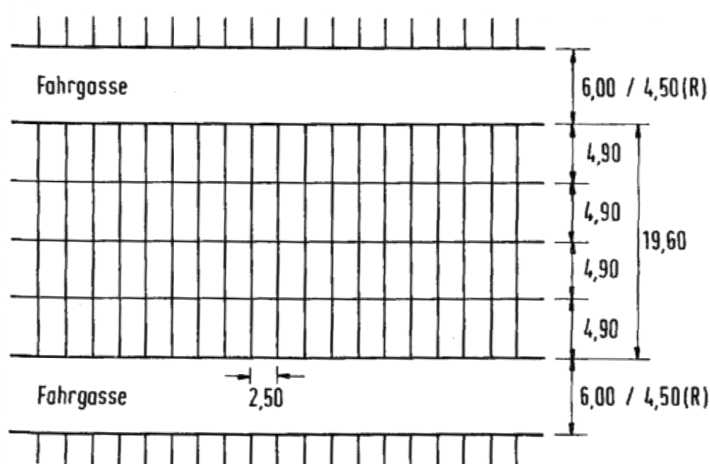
Dimenzije parkirnega modula za parkiranje osebnih vozil (EAR 05; str. 91)
